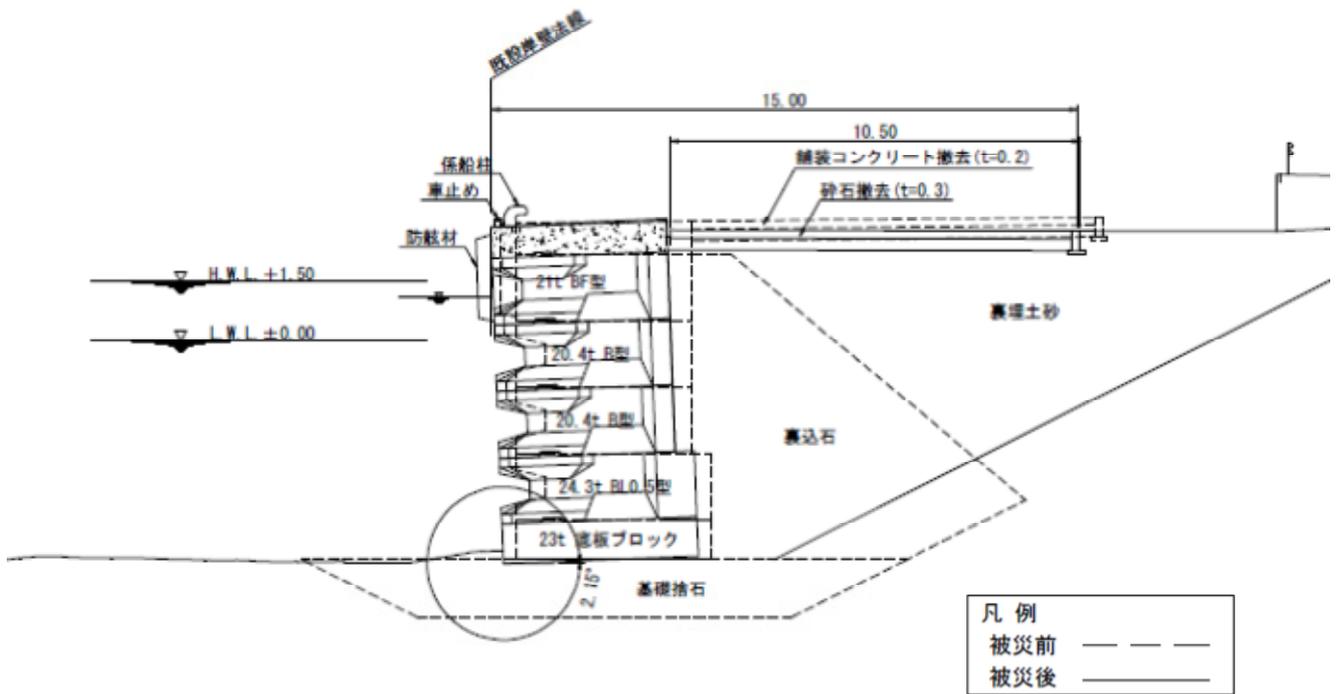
248 No.22 常陸那珂港区_南埠頭地区 B岸壁 (-5.5m) の断面図 (被災後)
